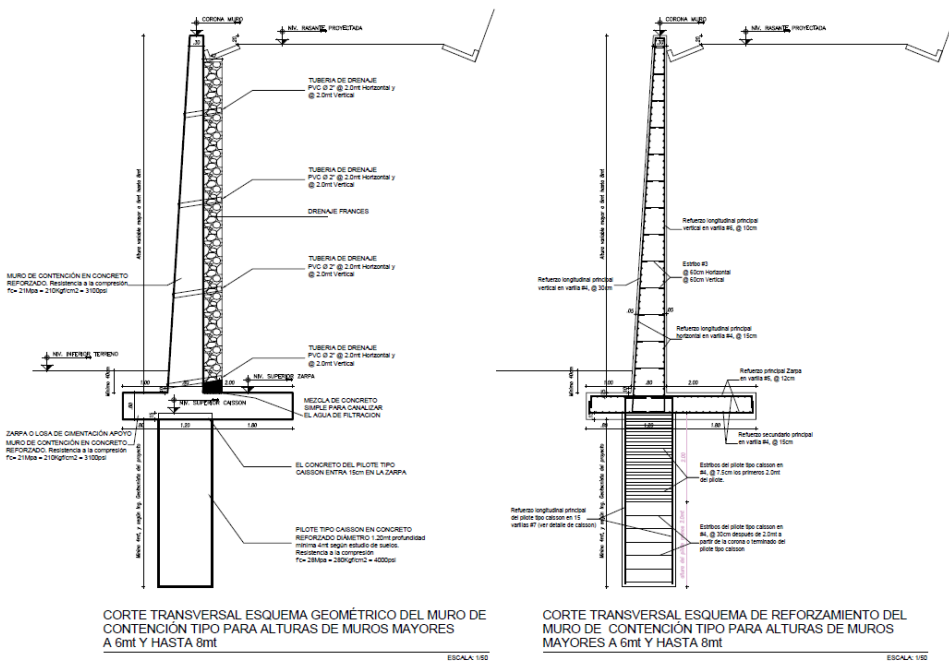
Detalle de los pilotes para muros de más de 6 metros de altura.
